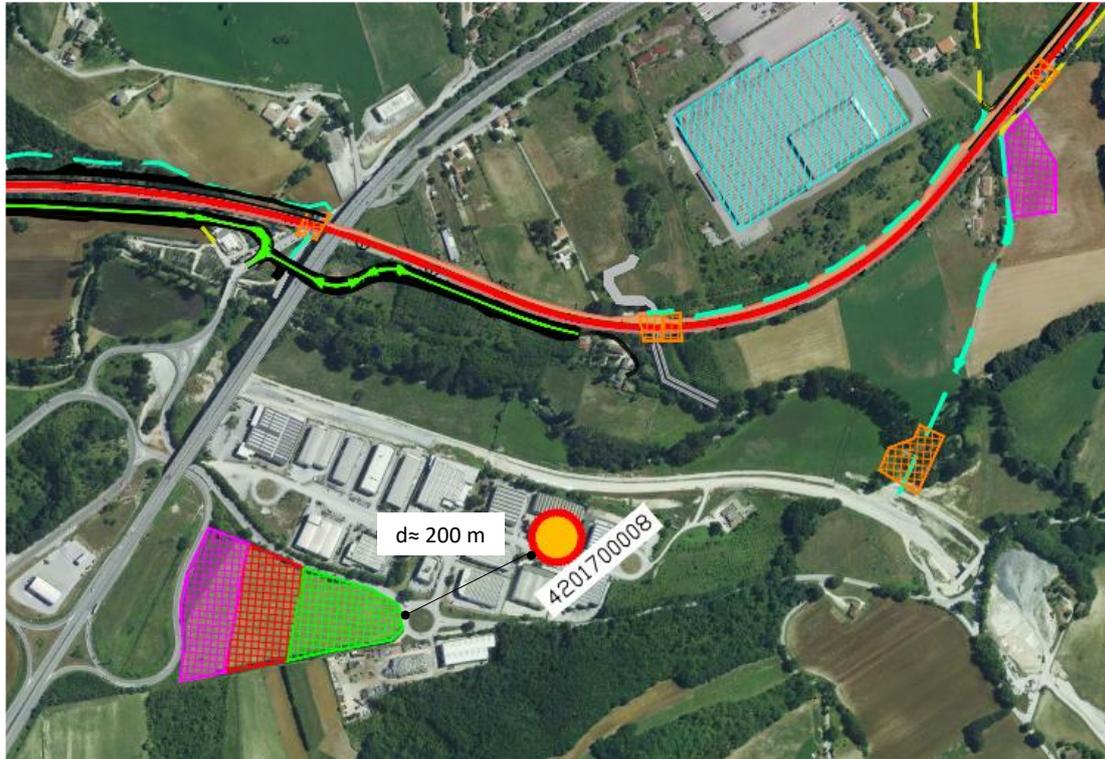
Sito contaminato e distanza rispetto all'area di cantiere più vicina, CO.01 (area in verde)
